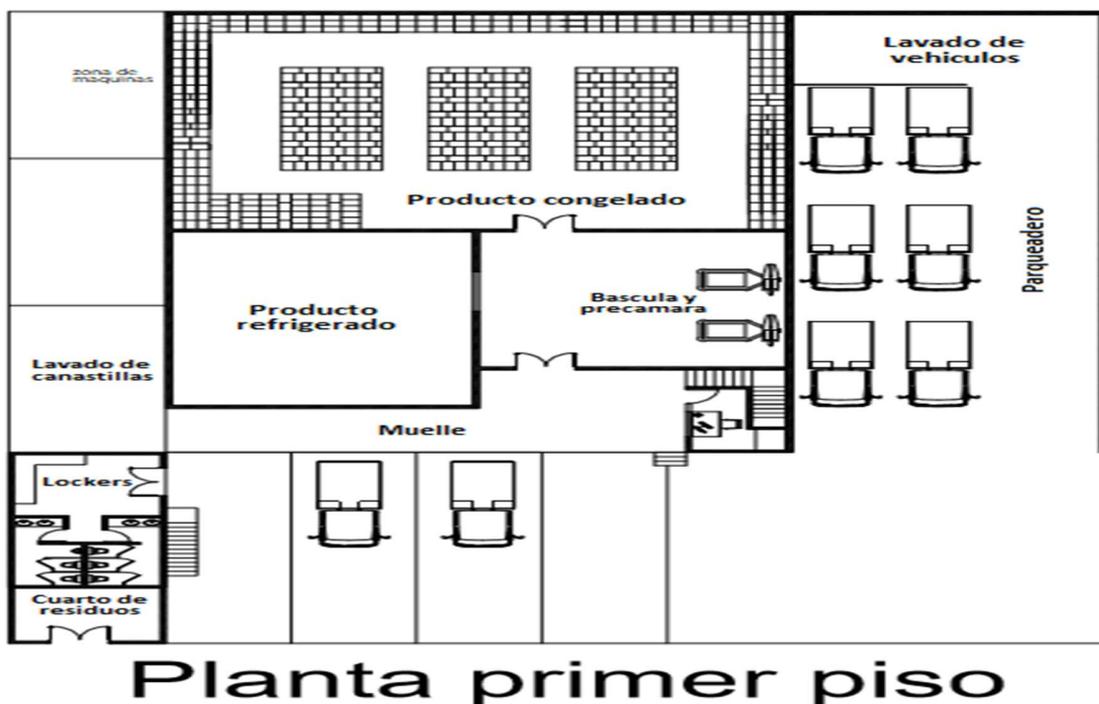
Plano del nuevo diseño en Autocad Planta primer piso.
